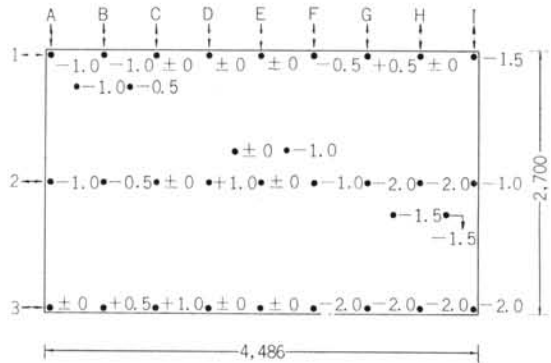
定盤の平面誤差の1例 (WA₃壁版型わく内側, 単位 mm)
